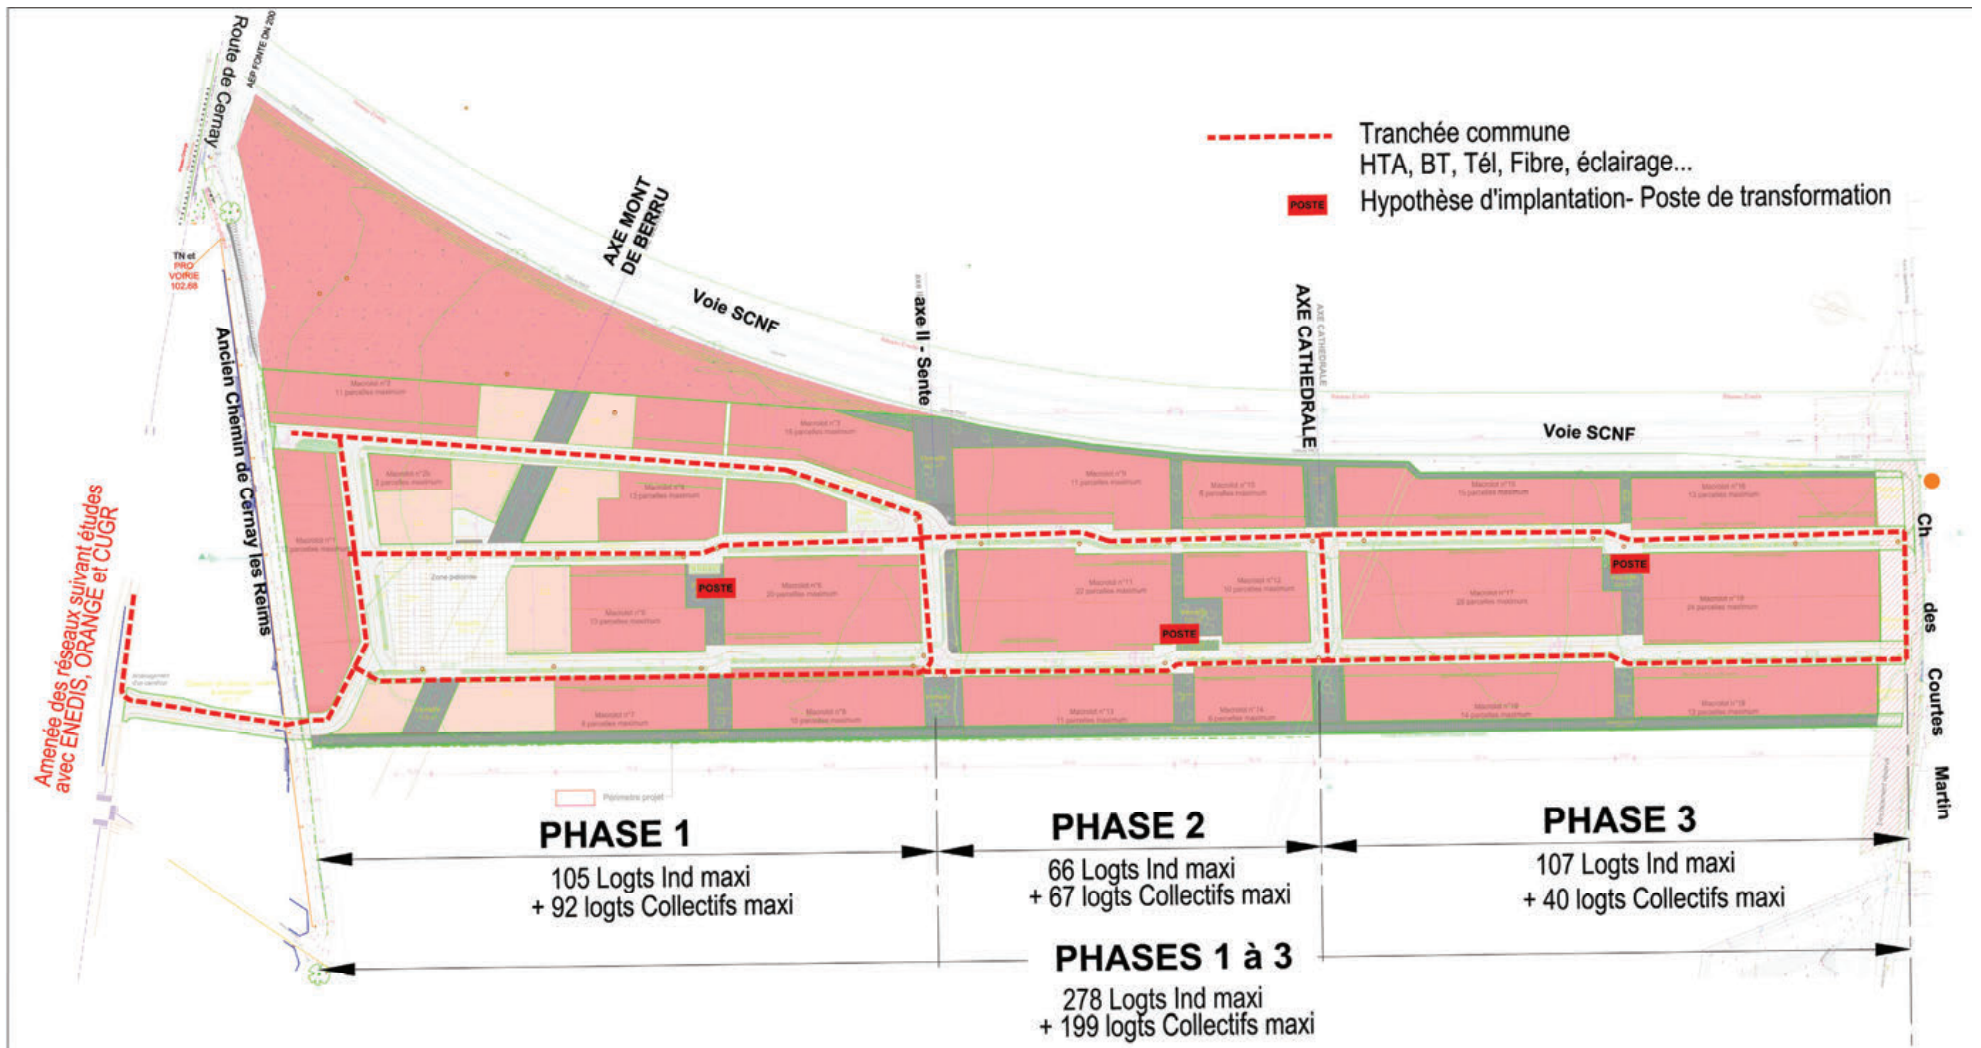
Plan des travaux prévus : réseaux secs (AWO)
